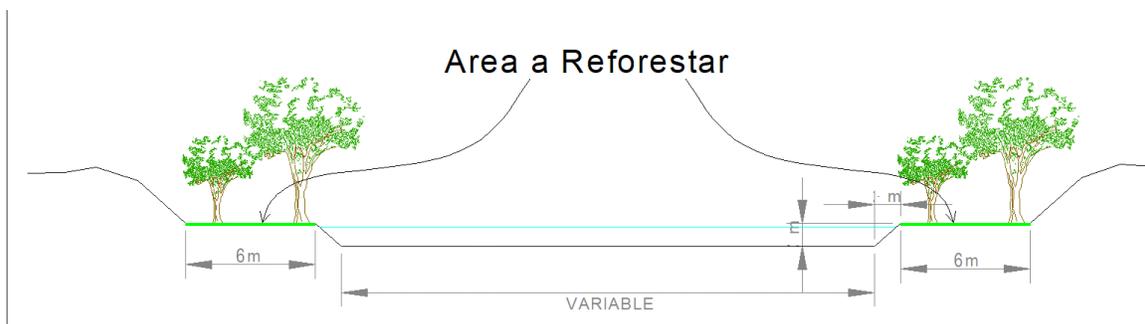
Sección tipo del cauce con el proyecto finalizado.
